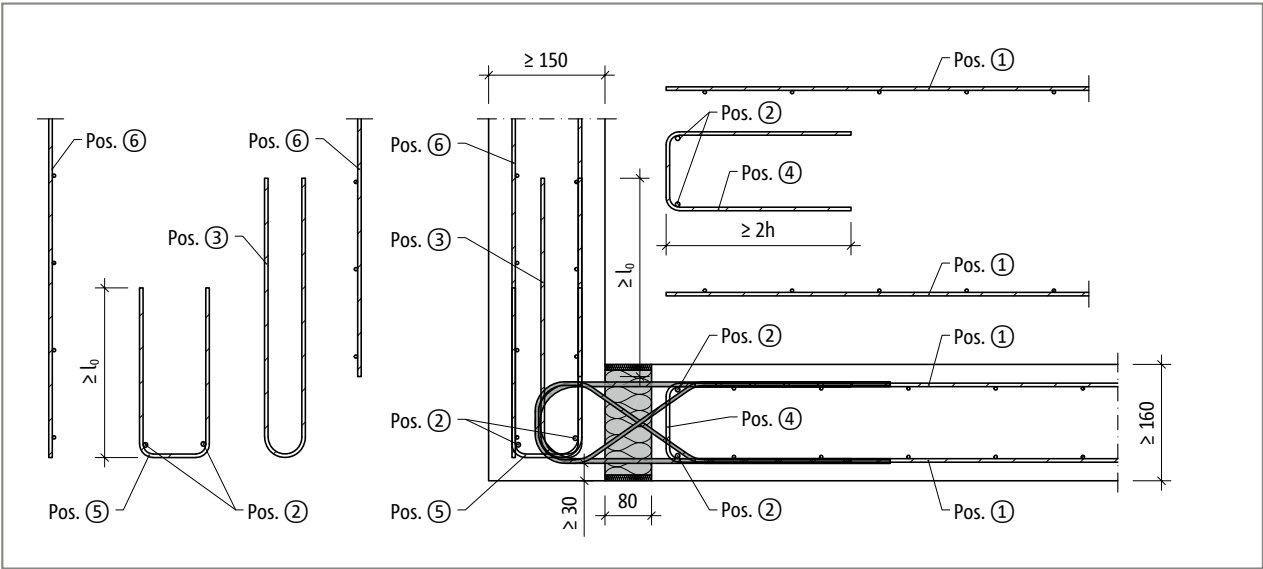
Schöck Isokorb® T tipo AP disposizione orizzontale: armatura in opera
